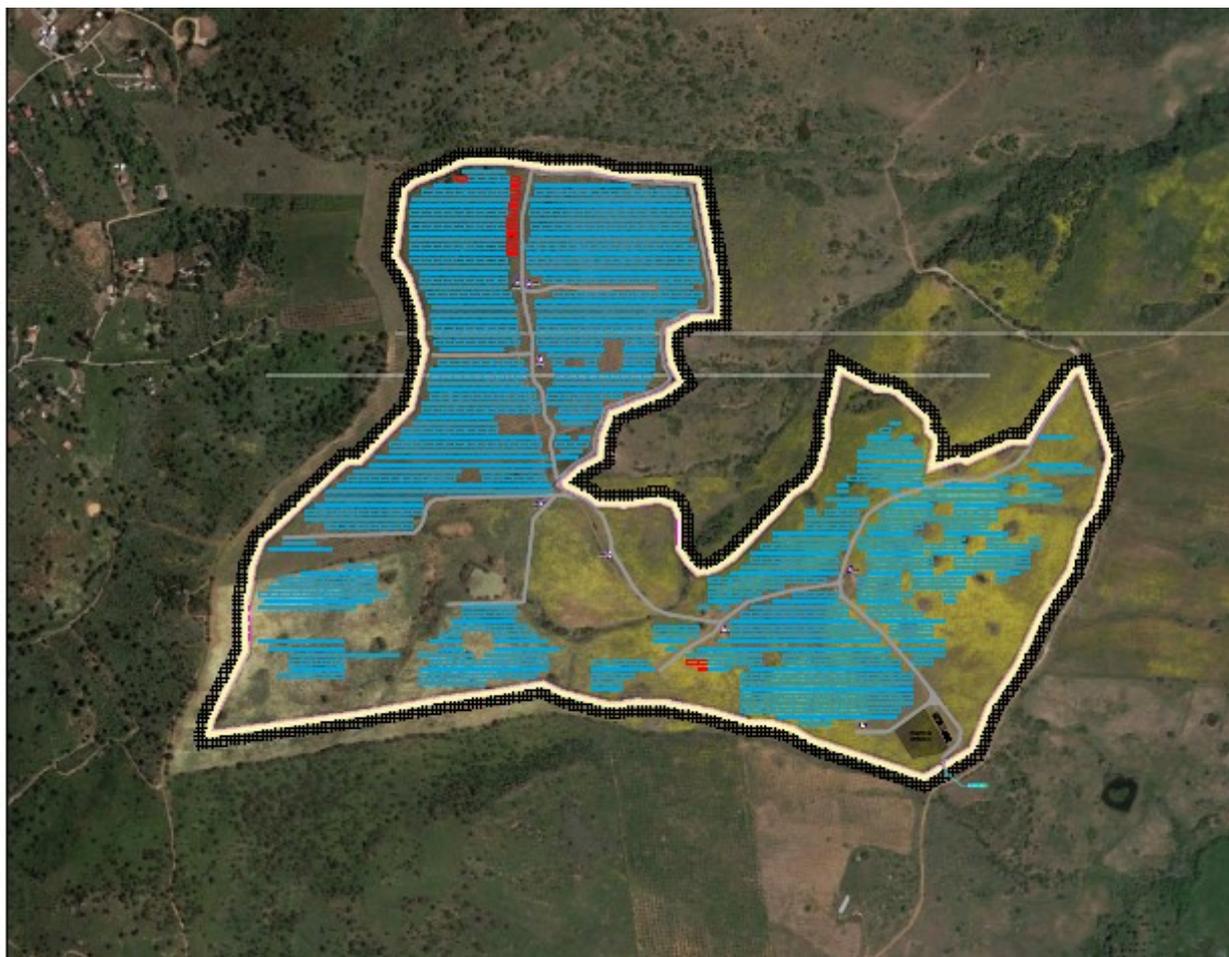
Stralcio Layout di Impianto (Progetto Definitivo)
